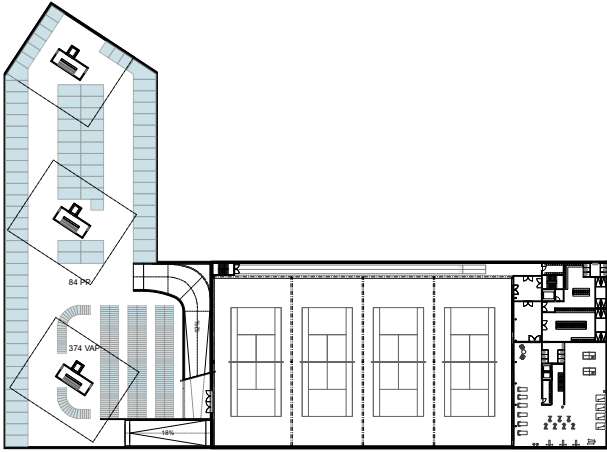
Einstellhalle im ersten Untergeschoss (Parkierung Auto und Veloabstellplätze)
